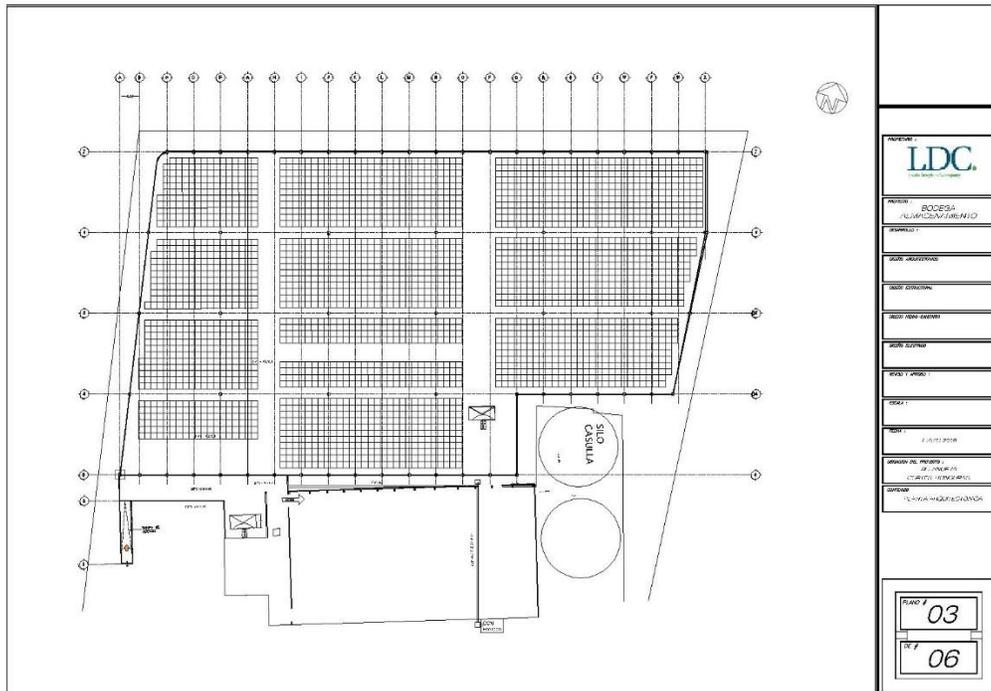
Planta Arquitectónica para la nave de almacenamiento
